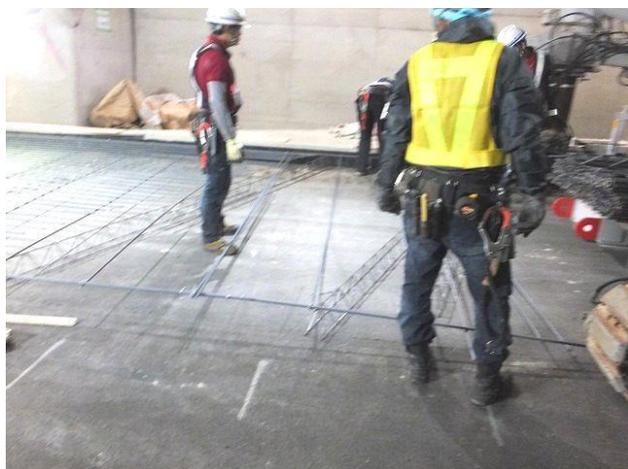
③ コンクリート打設に先立ち鉄筋の加工組み立てがおこなわれている。
